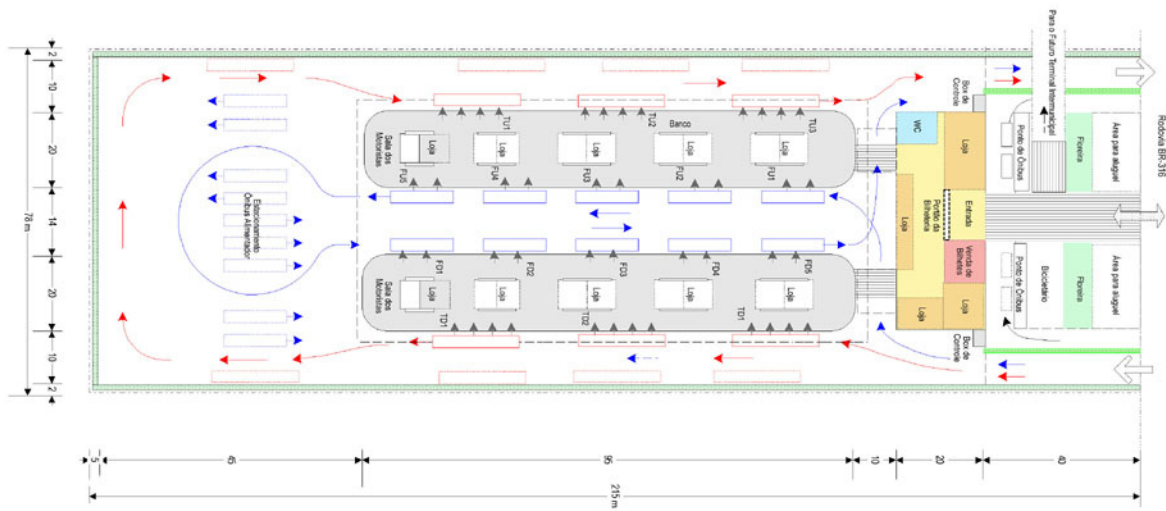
Localização e Planta do Terminal F: Marituba (sem escala)
